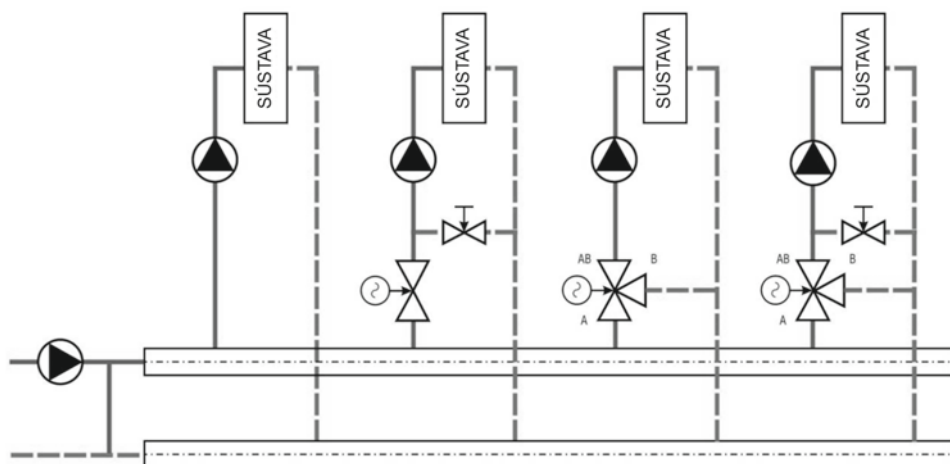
Tlakový rozdeľovač s premenným prietokom
